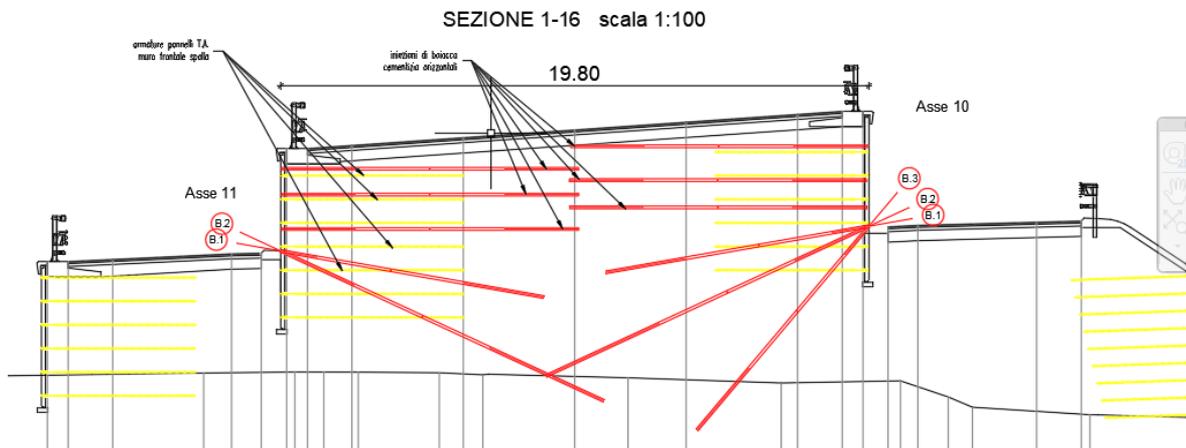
Disposizione delle iniezioni nel tratto a tergo della Spalla 2 del Viadotto 1
